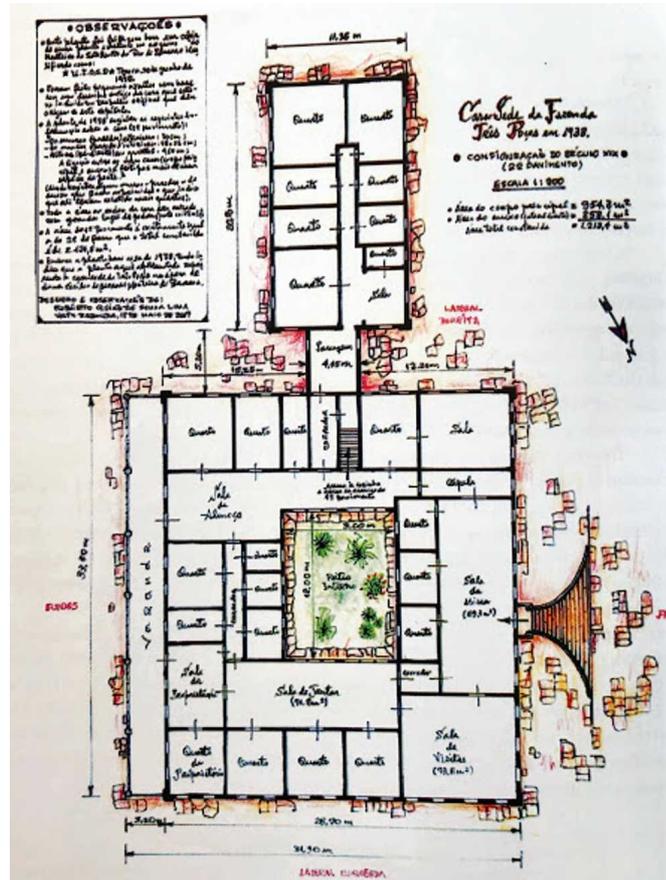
Planta baixa da casa-sede configuração em final do sec. XIX
